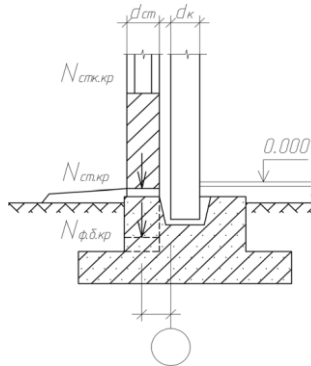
Схема для розрахунку моменту від ваги стінового огорожі, ваги застклення і фундаментної балки.
